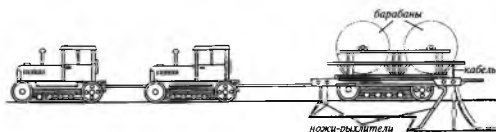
Прокладка кабеля дальней связи в грунт
